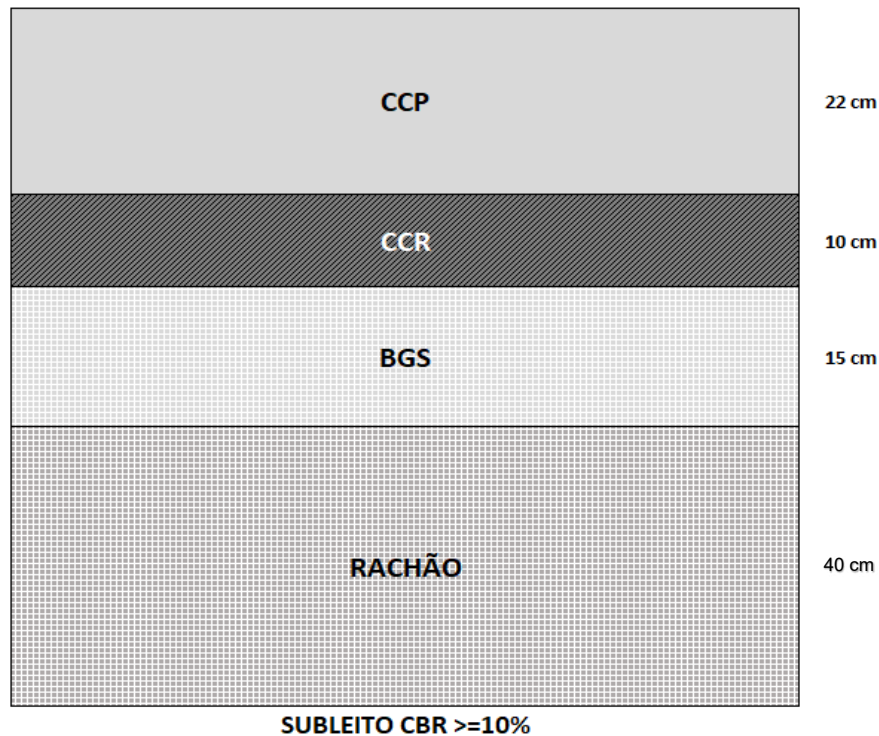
Esquemática da estrutura do Pavimento Tipo 3 – Rígido
